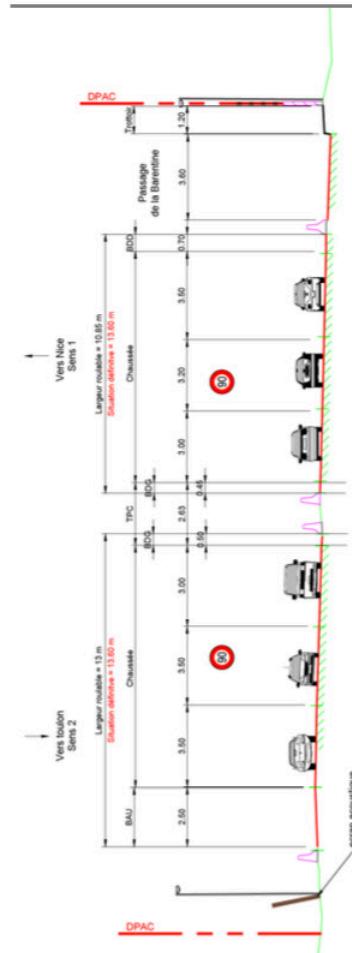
Profil en travers de l'A57 entre Benoit Malon et La Palasse
